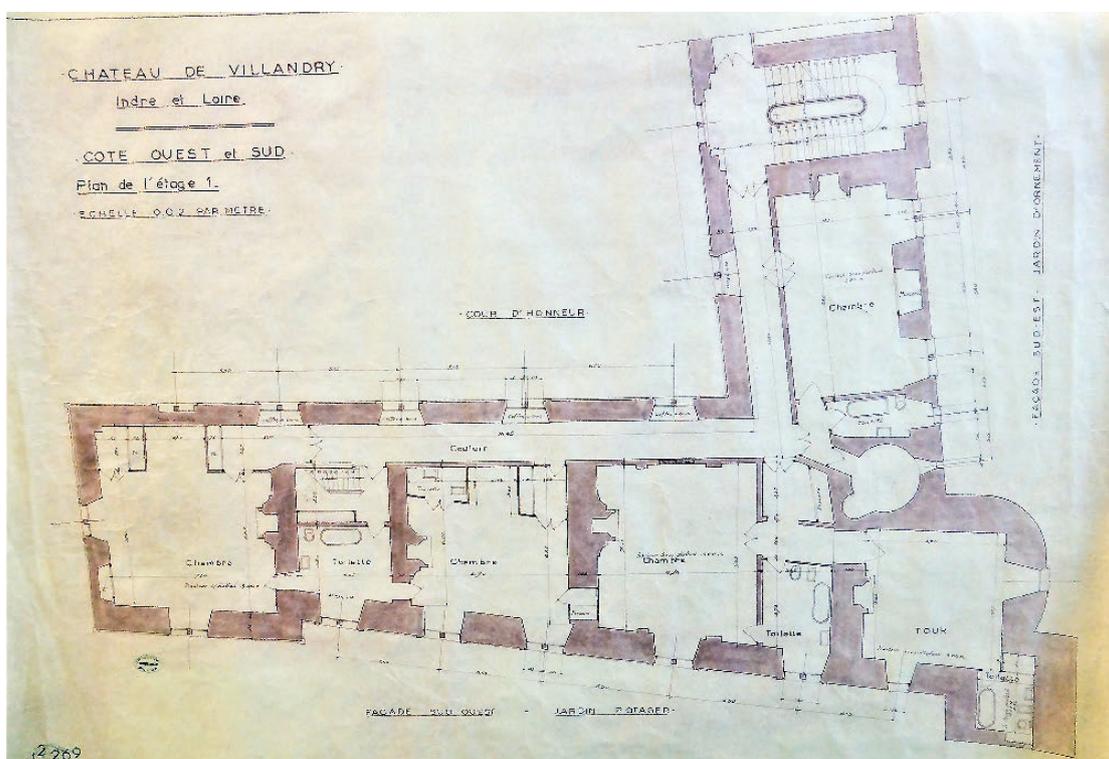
Plan du premier étage du corps central et de l'aile droite, fin du XIX^e siècle (AD 37, Villandry, plans, IV/55-4).
